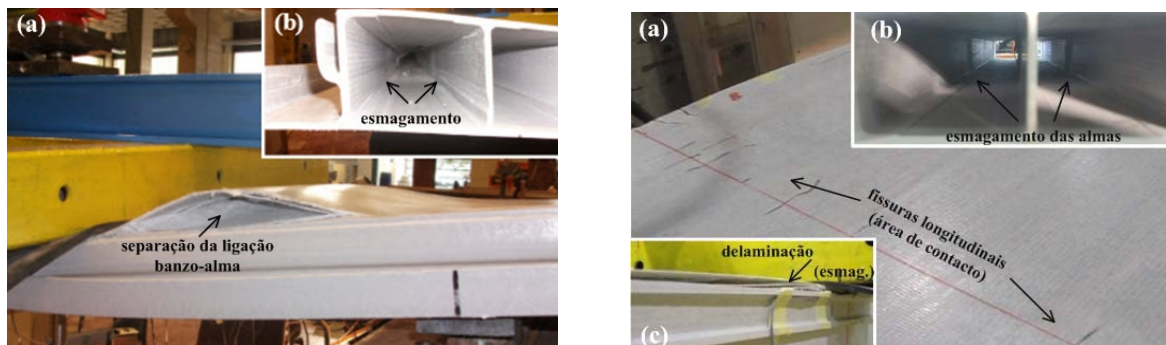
Roturas dos painéis: à esquerda – FLn.1 – (a) delaminação do banzo, (b) esmagamento das almas; e à direita – FLn.4 – (a) fissuração do banzo, (b) esmagamento das almas, (c) delaminação do banzo.
